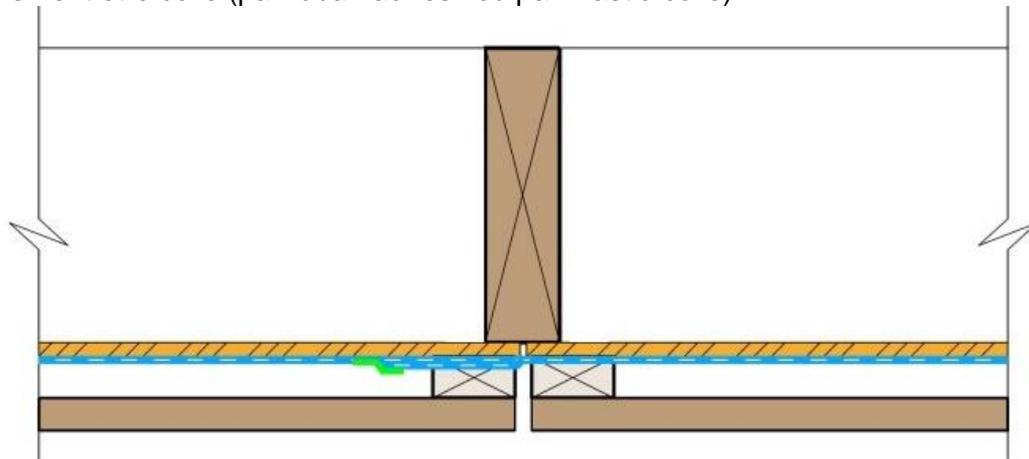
Simple recouvrement collé derrière un bardage à joints ouverts (coupe horizontale)
